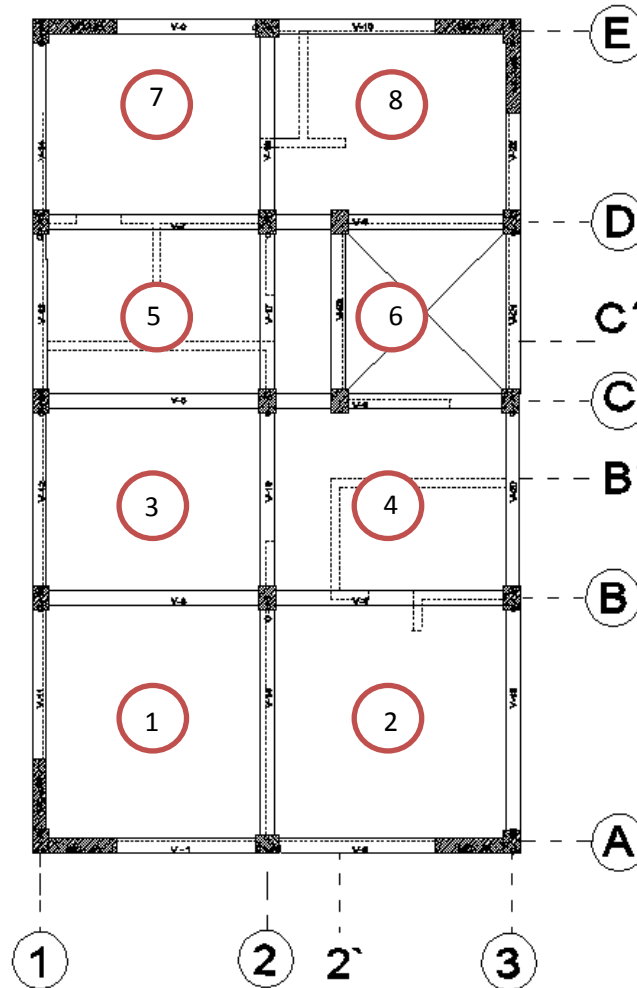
ESTRUCTURACIÓN – SISTEMA DUAL TIPO I
